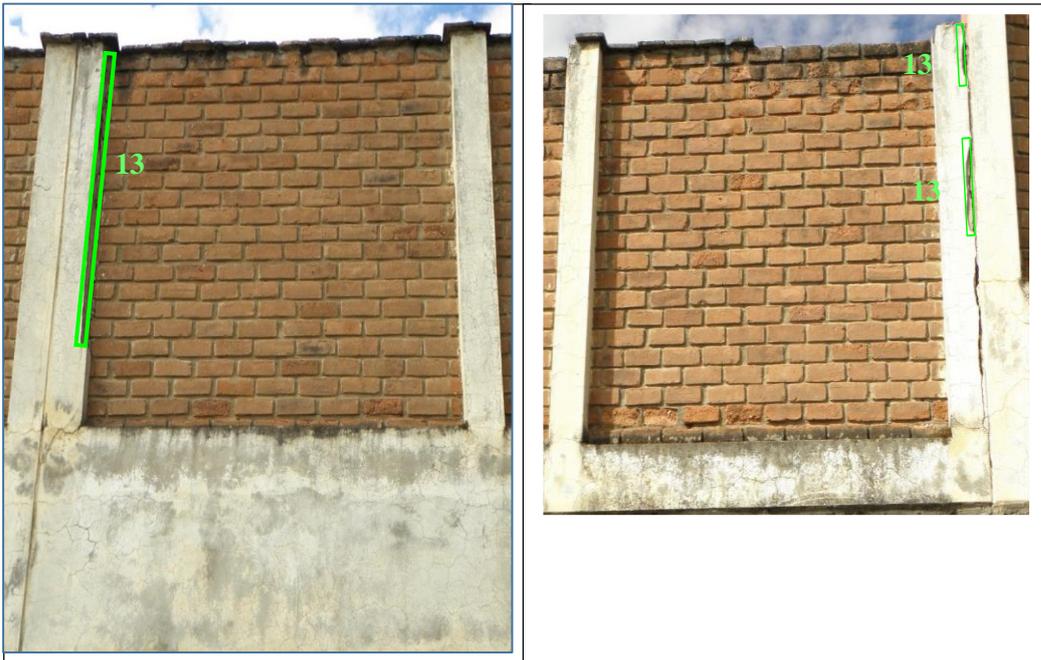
Fisuras de retracción de mortero en muros de albañilería.
